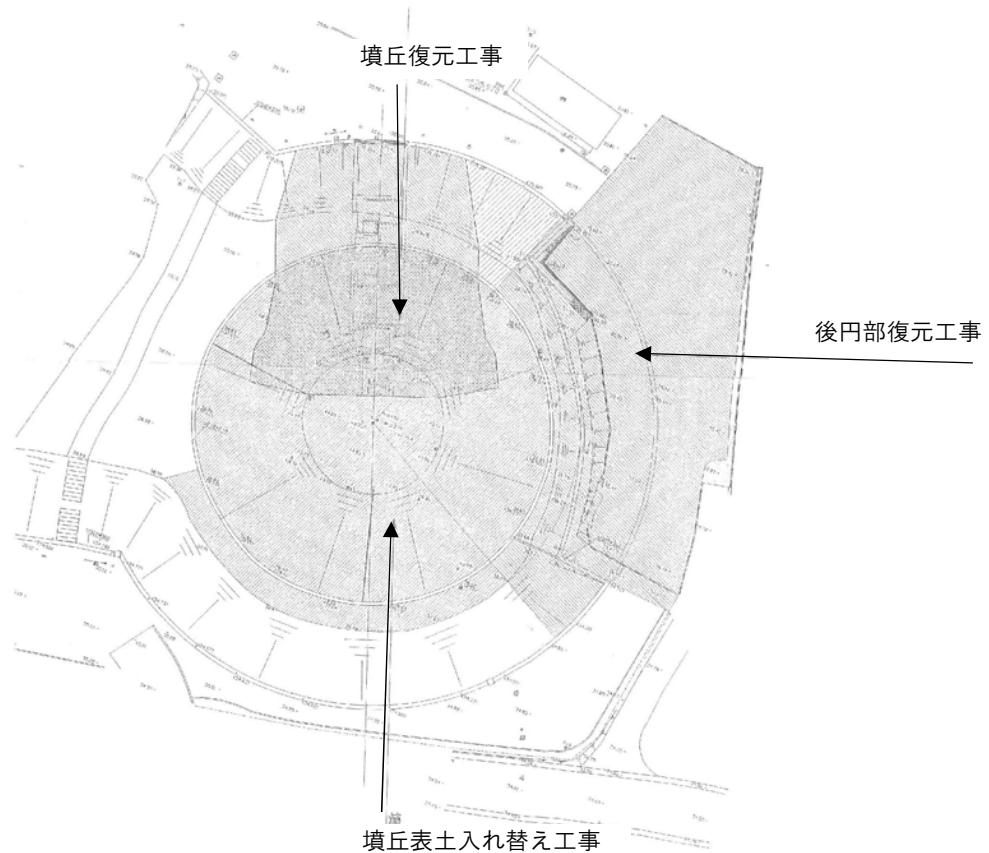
：後円部復元工事及び石室浸水対策工事平面図
